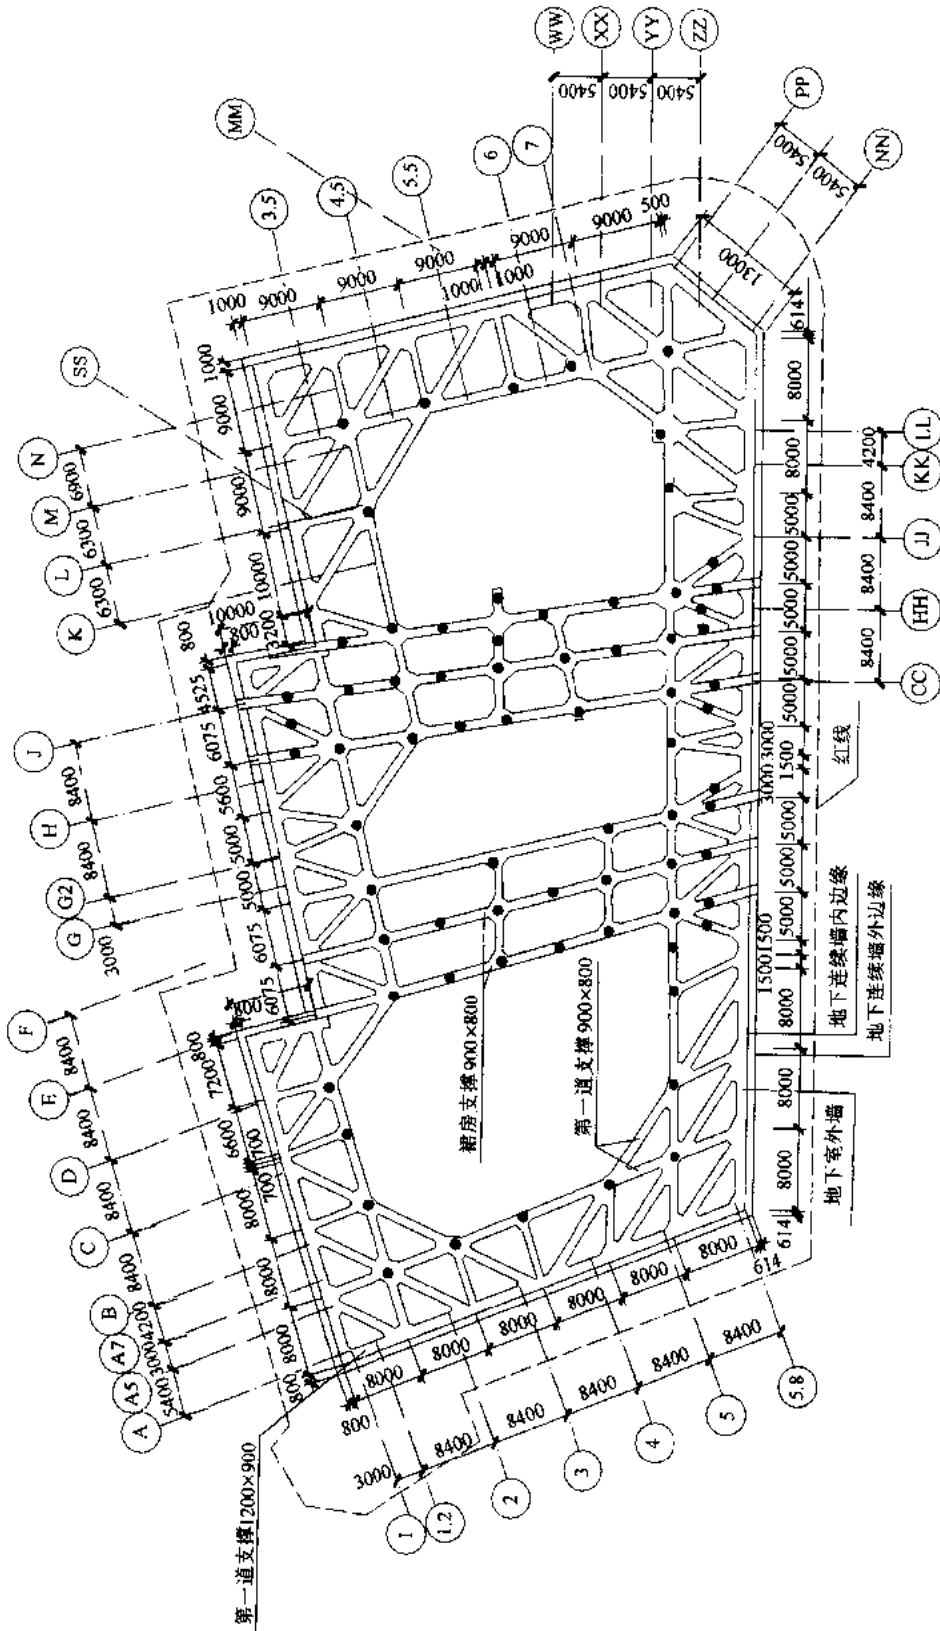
第一道围檩、支撑及钢立柱平面布置示意图
